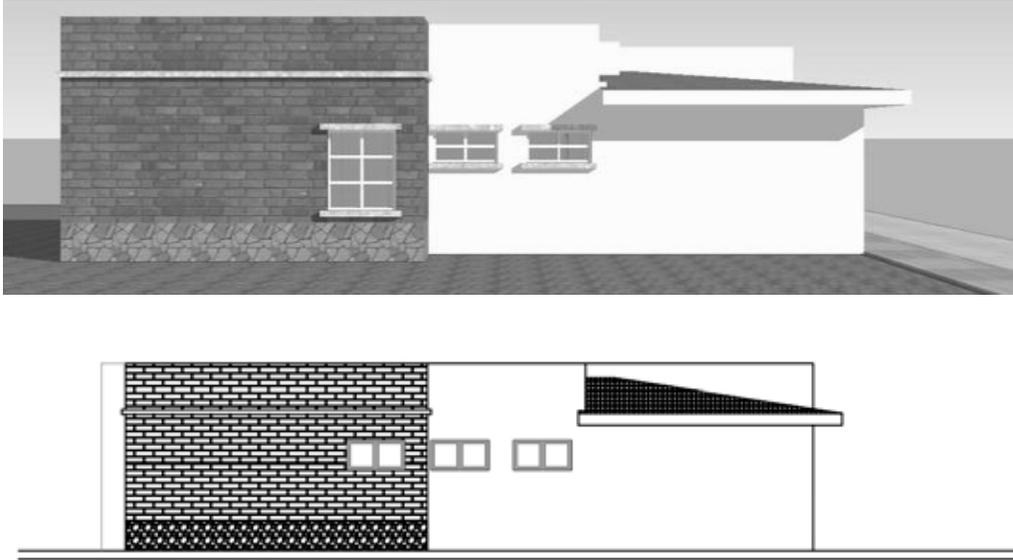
Fachada lateral del proyecto arquitectónico de la vivienda tipo 2.
